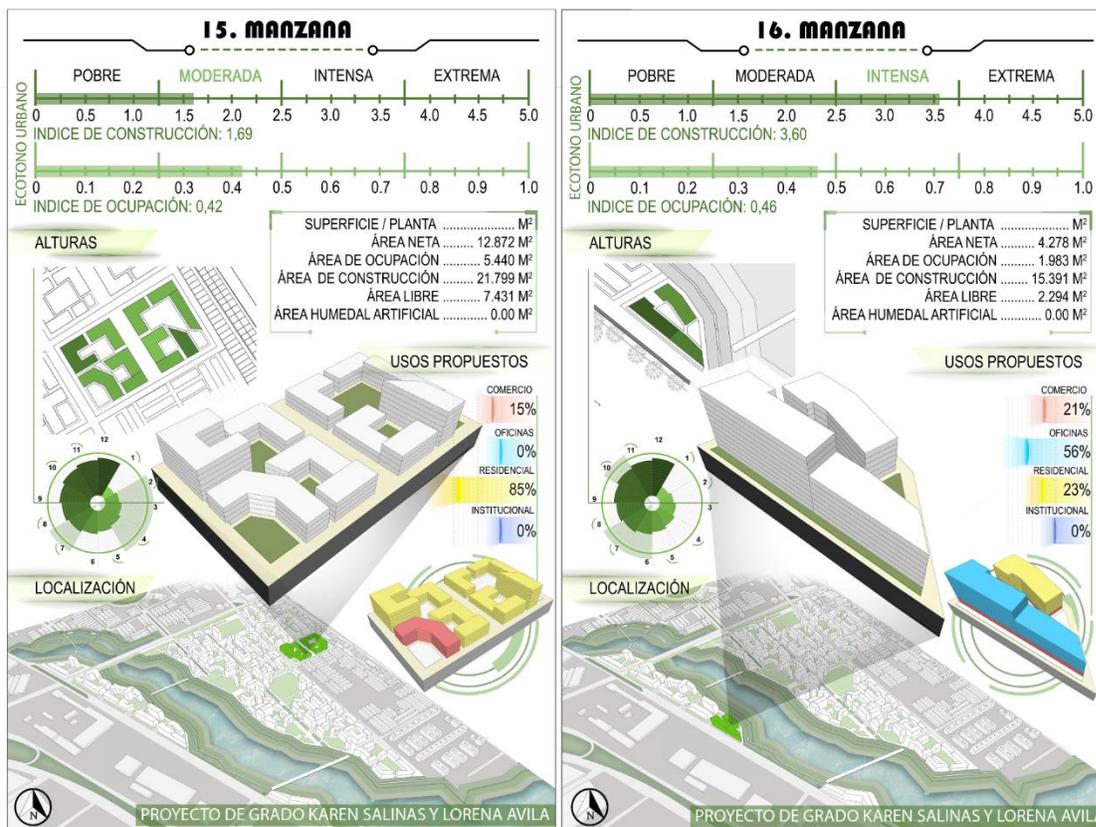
Manzana 15 y 16. Autoría propia (2019)
